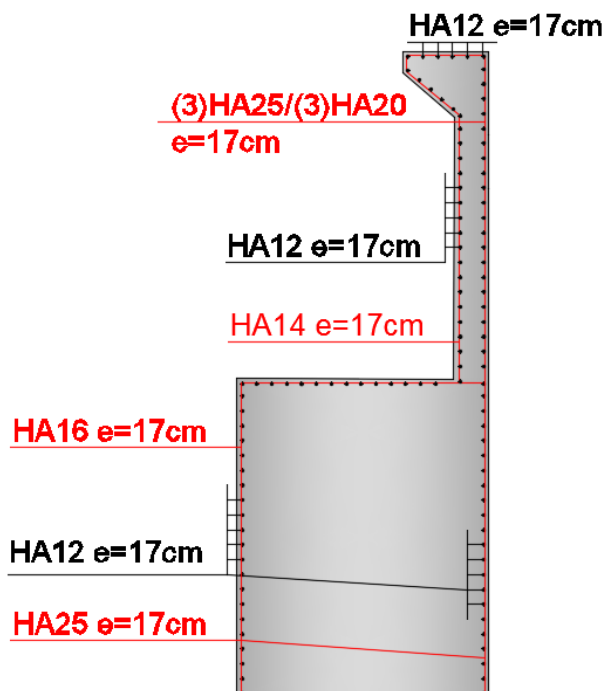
Ferrailage du mur garde grève + mur frontale.
